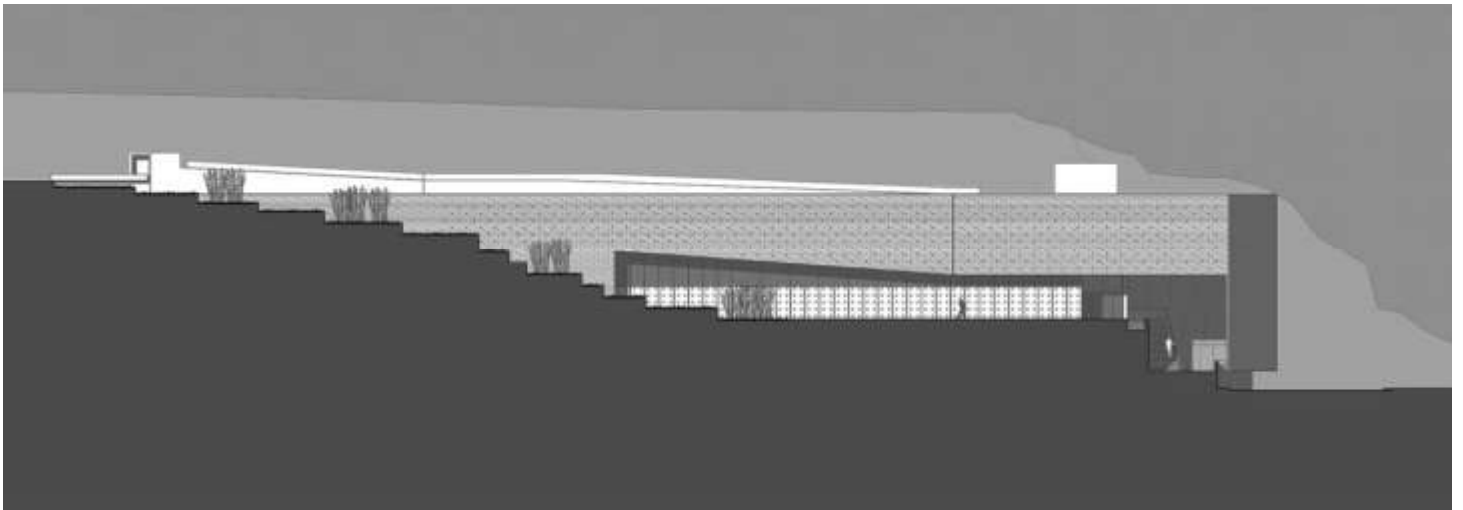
LUM. Elevación fachada norte. Estudio Barclay & Crousse
